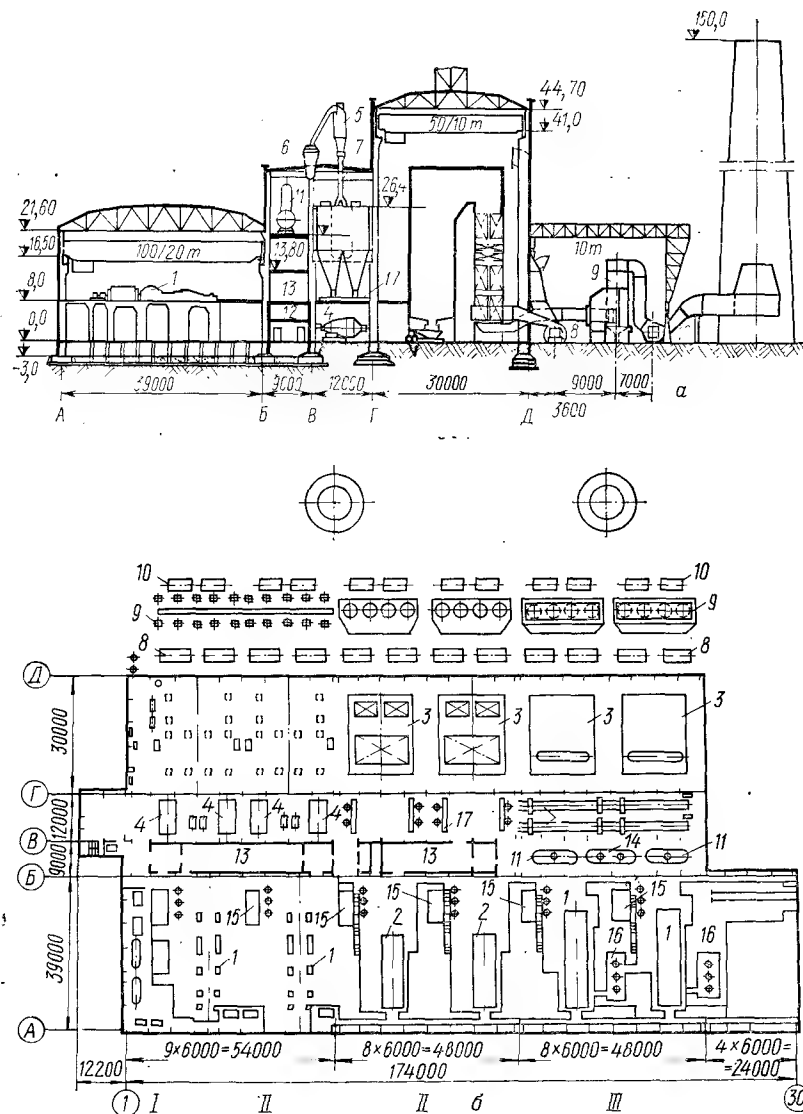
Поперечный разрез (а) и план (б) главного здания ТЭЦ-350 МВт.
